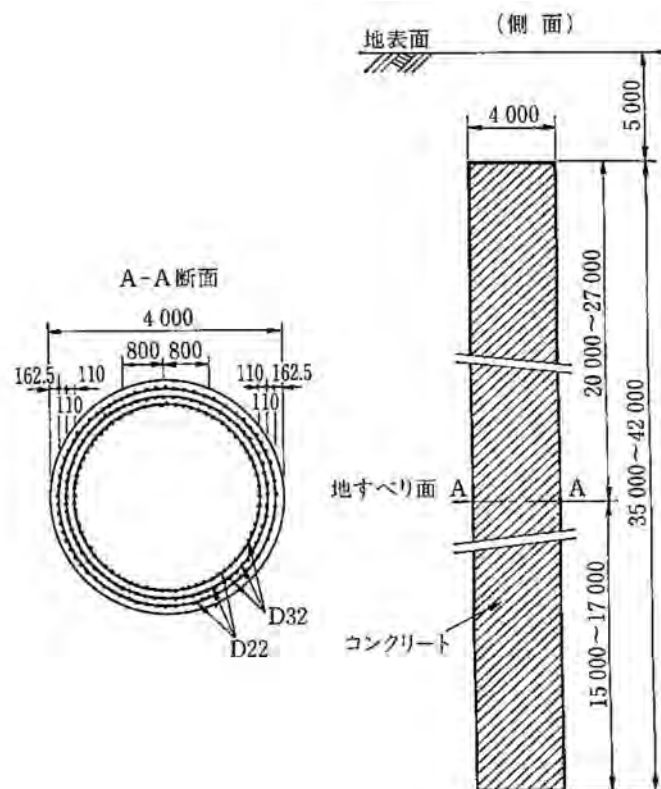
シャフト工の例 (単位: mm) ²⁶
